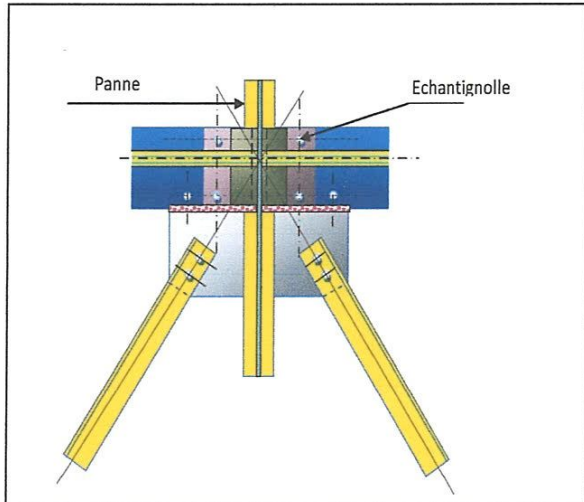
Assemblage 3 : gousset d'assemblage soudé dans le prolongement de l'épaisseur de la membrure ferme
